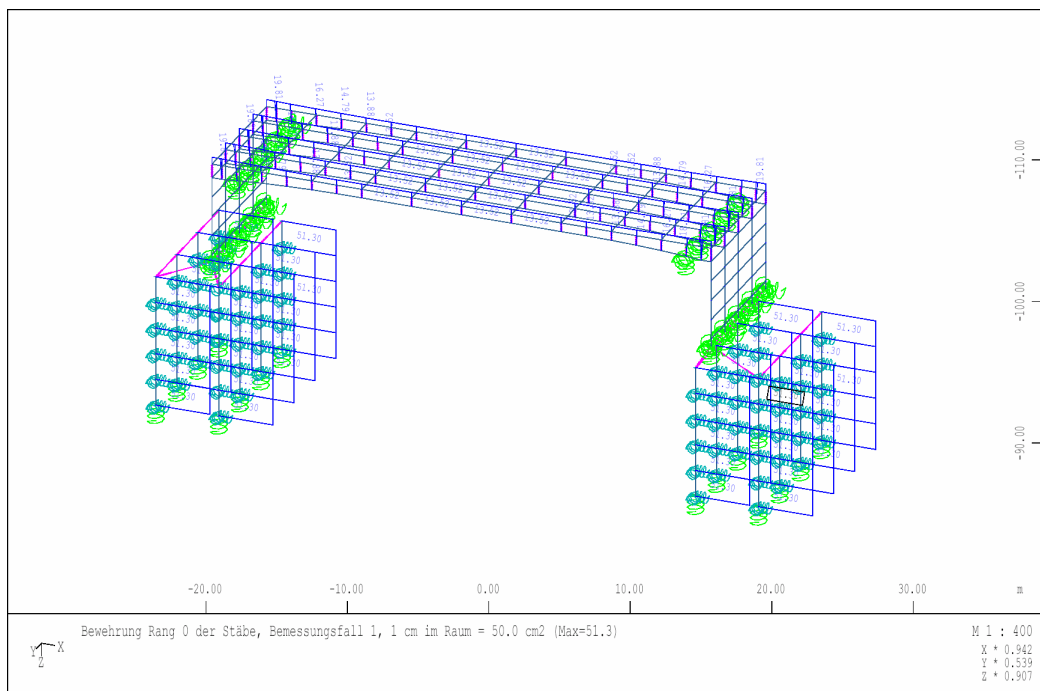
erforderliche Bewehrung im GZG ($w_k = 0,2$ mm) Rang 0
